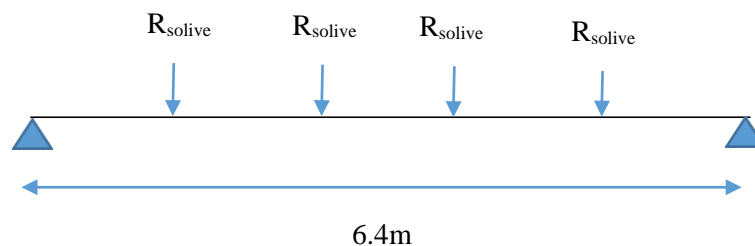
Schéma statique de poutre principale de la buanderie.
